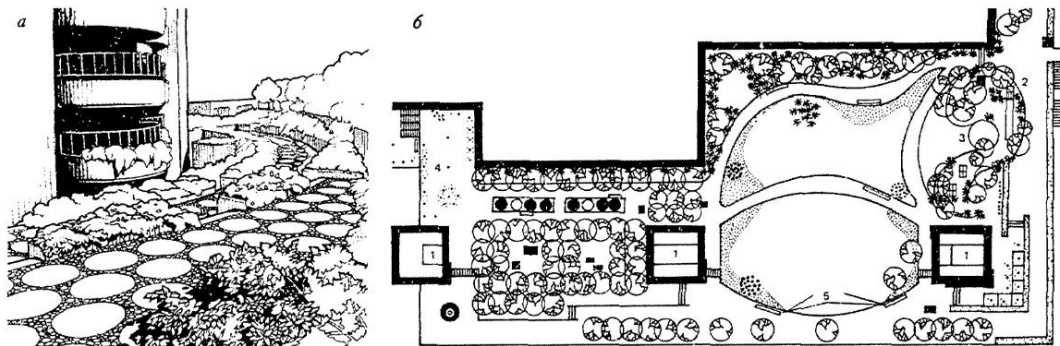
а, б. Сады на крышах жилого дома и производственного здания: 1 – лифтовые шахты; 2 – ветрозащитная стенка; 3 – навесы; 4 – столы со стульями; 5 – пергола
